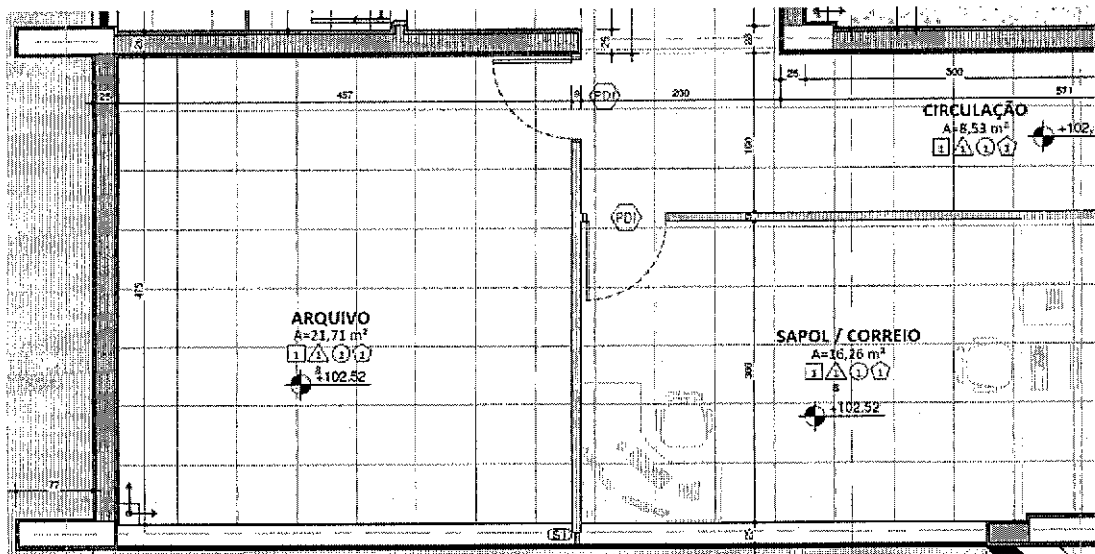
planta do térreo da obra DRF Bauru (CAT 2620180009585), área de arquivo SAPOL com 21,71m². Obra de Construção.
